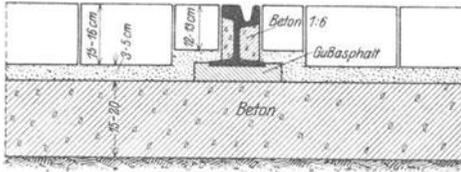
Schiene in Reihensteinpflaster auf durchgehendem Betonbett.
